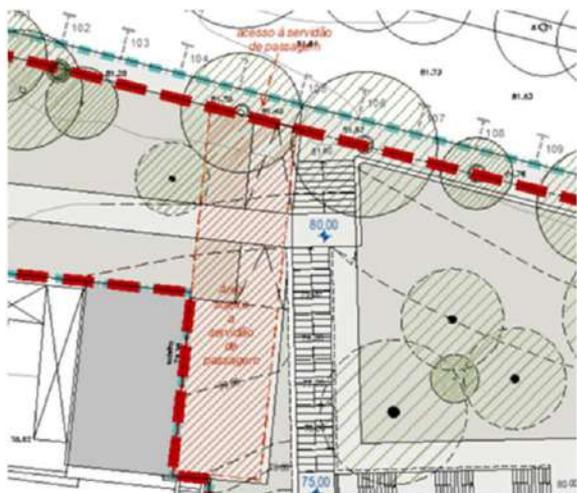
Planta Síntese (desenho LOT-007 (R1), Maio 2023).
